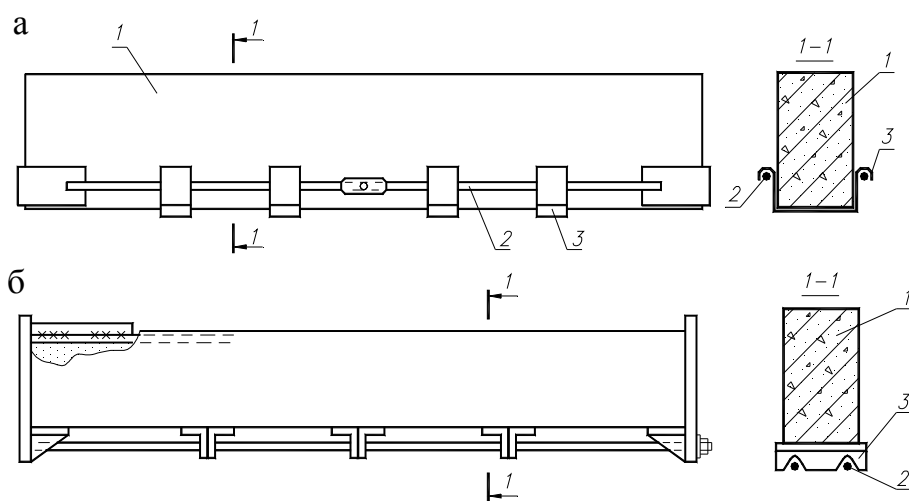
Расположение соединительных прокладок на затяжках: *а* – на боковых гранях; *б* – на нижней грани, 1 – усиливаемая конструкция, 2 – затяжка, 3 – соединительные прокладки
